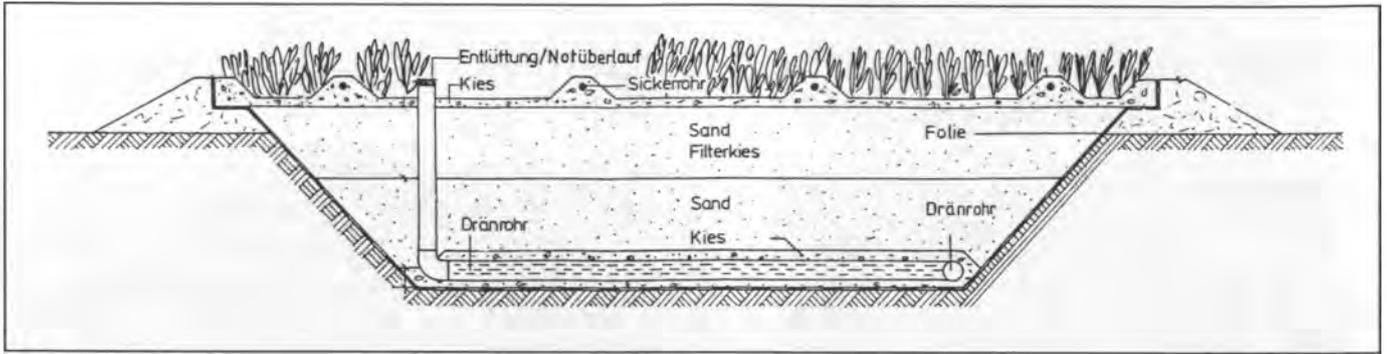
Querschnittszeichnung zum Aufbau der Filterbeete
